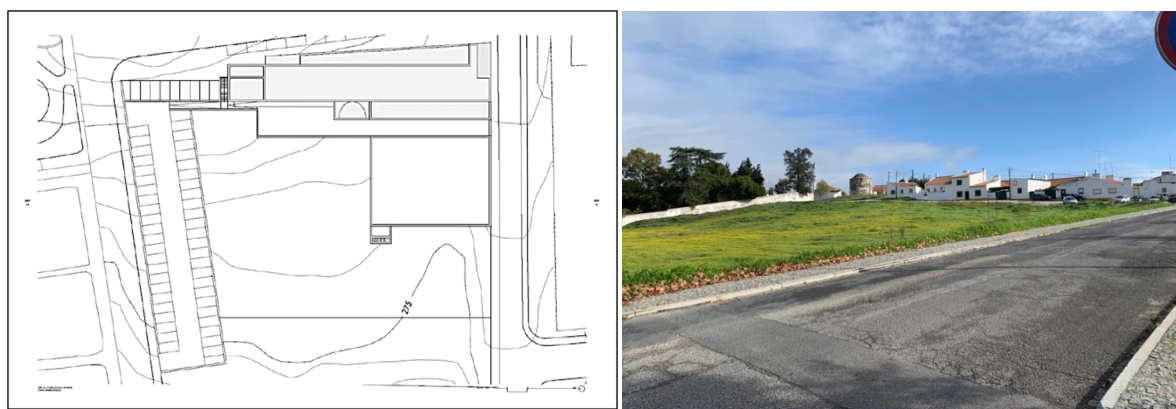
; Planta ²⁷ da sede da Cooperativa da Boa Vontade e terreno previsto para a construção.
